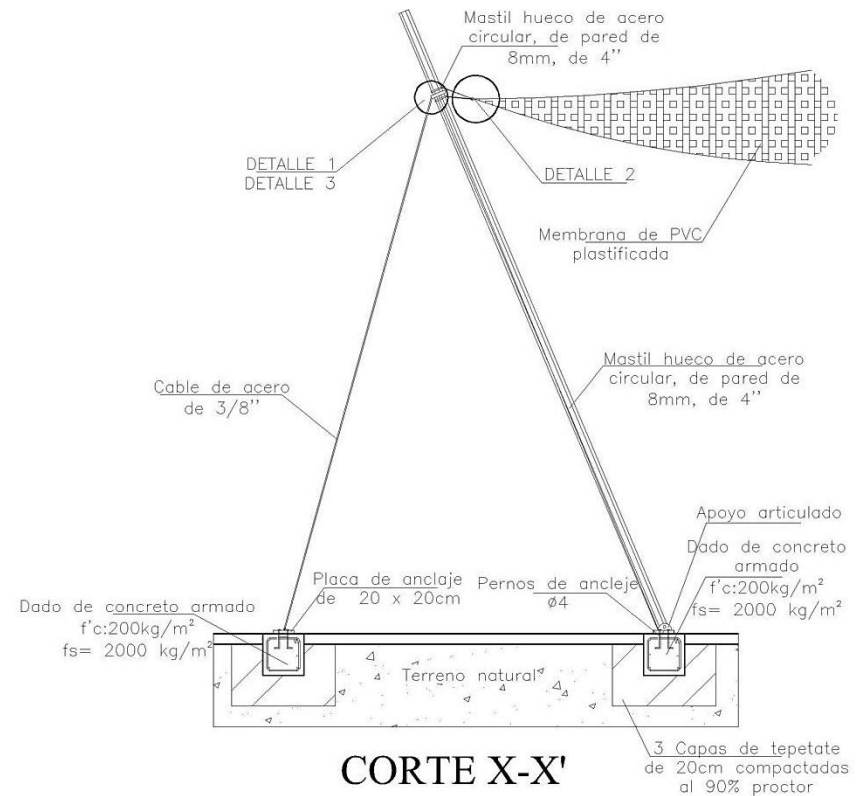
Corte por fachada Centro de Educación Ecológica Ameyalli, extracto plano ES-4.
